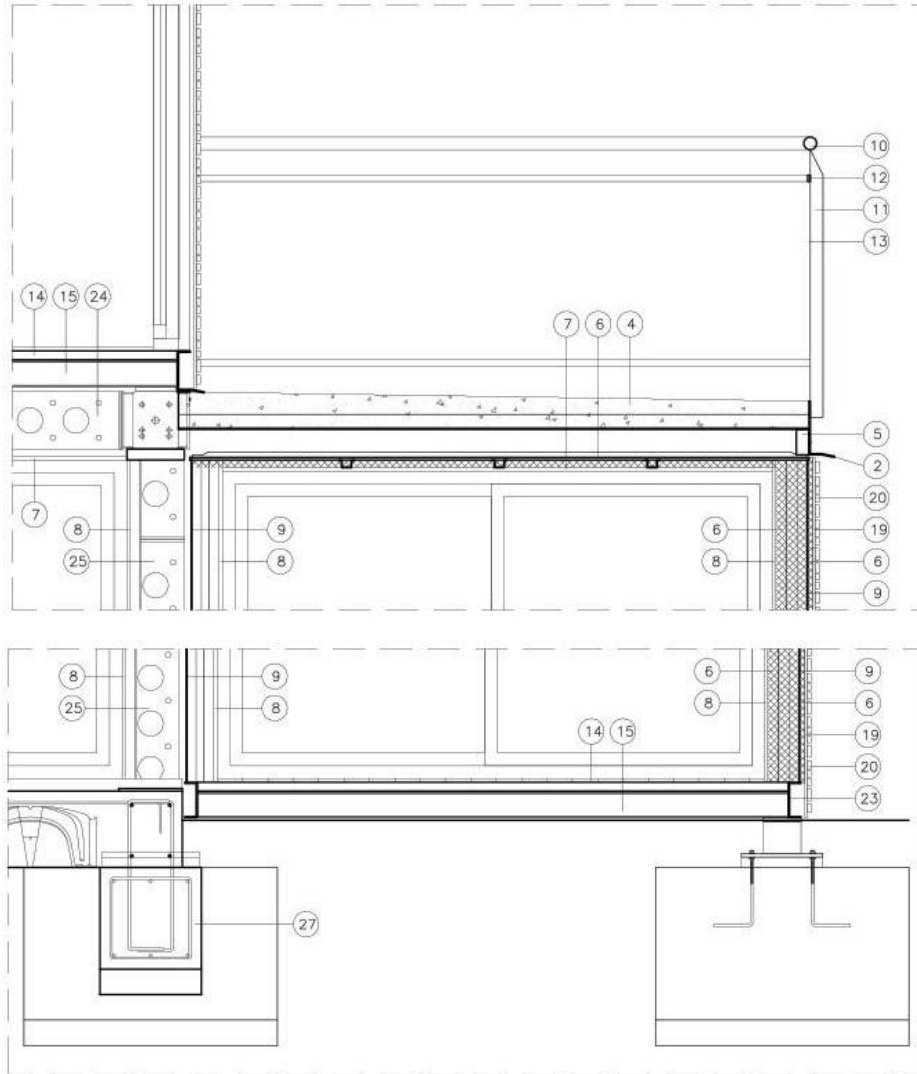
Detalles. Fuente:( straddle3.net.2016)
